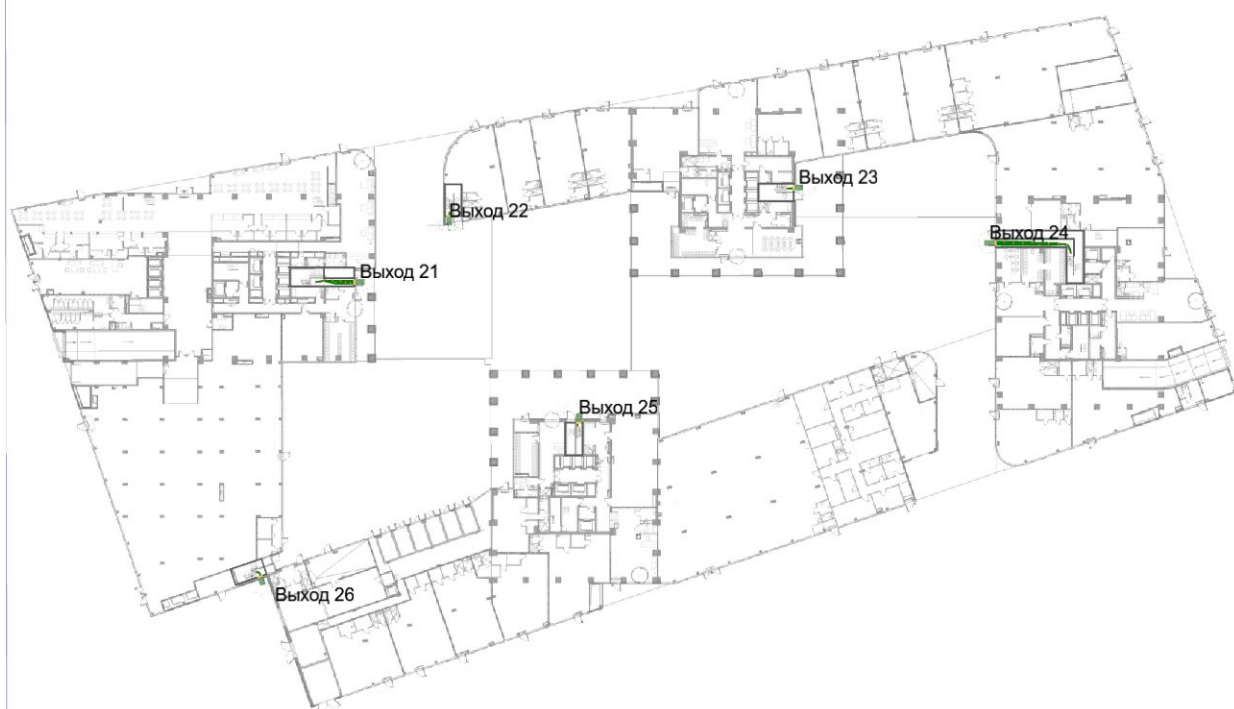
План 1-го этажа и нанесенная на него расчетная (принципиальная) схема эвакуации
